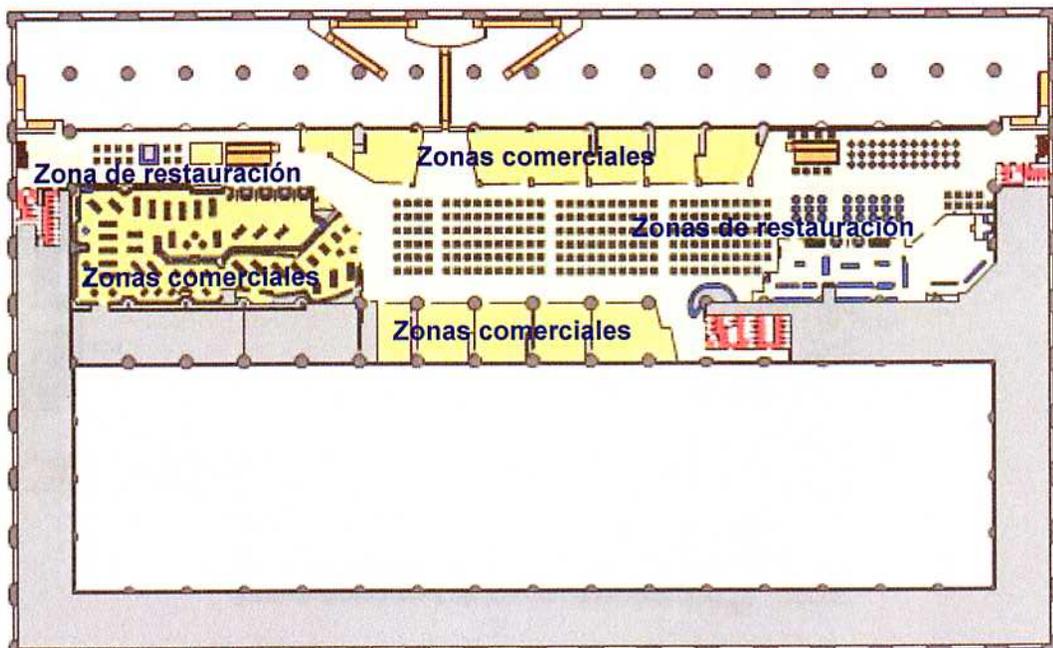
Planta segunda (Nivel 13). Terminal T2
